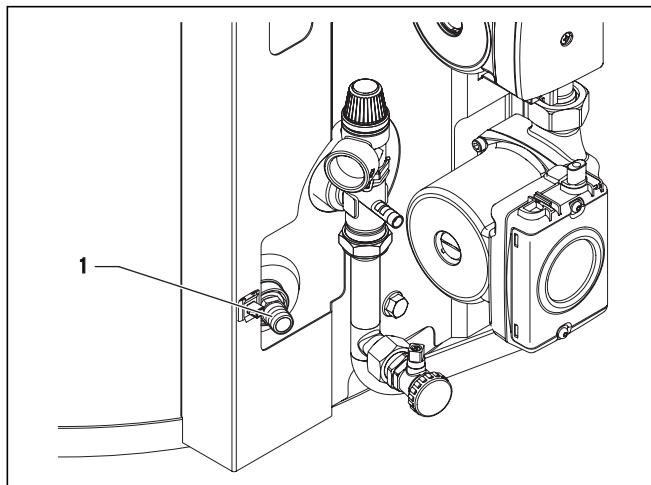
Вентиль опорожнения водонагревателя холодной водопроводной воды
